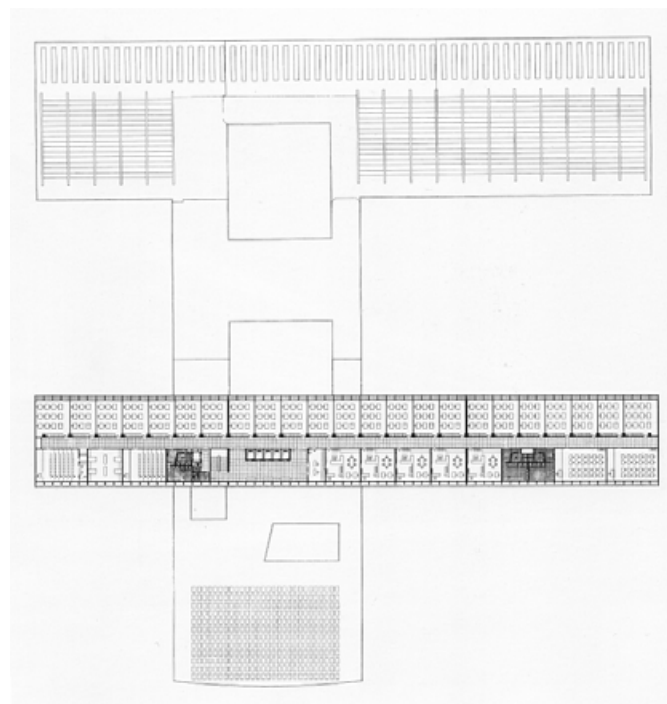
Planta baixa do pavimento tipo (terceiro ao oitavo).
